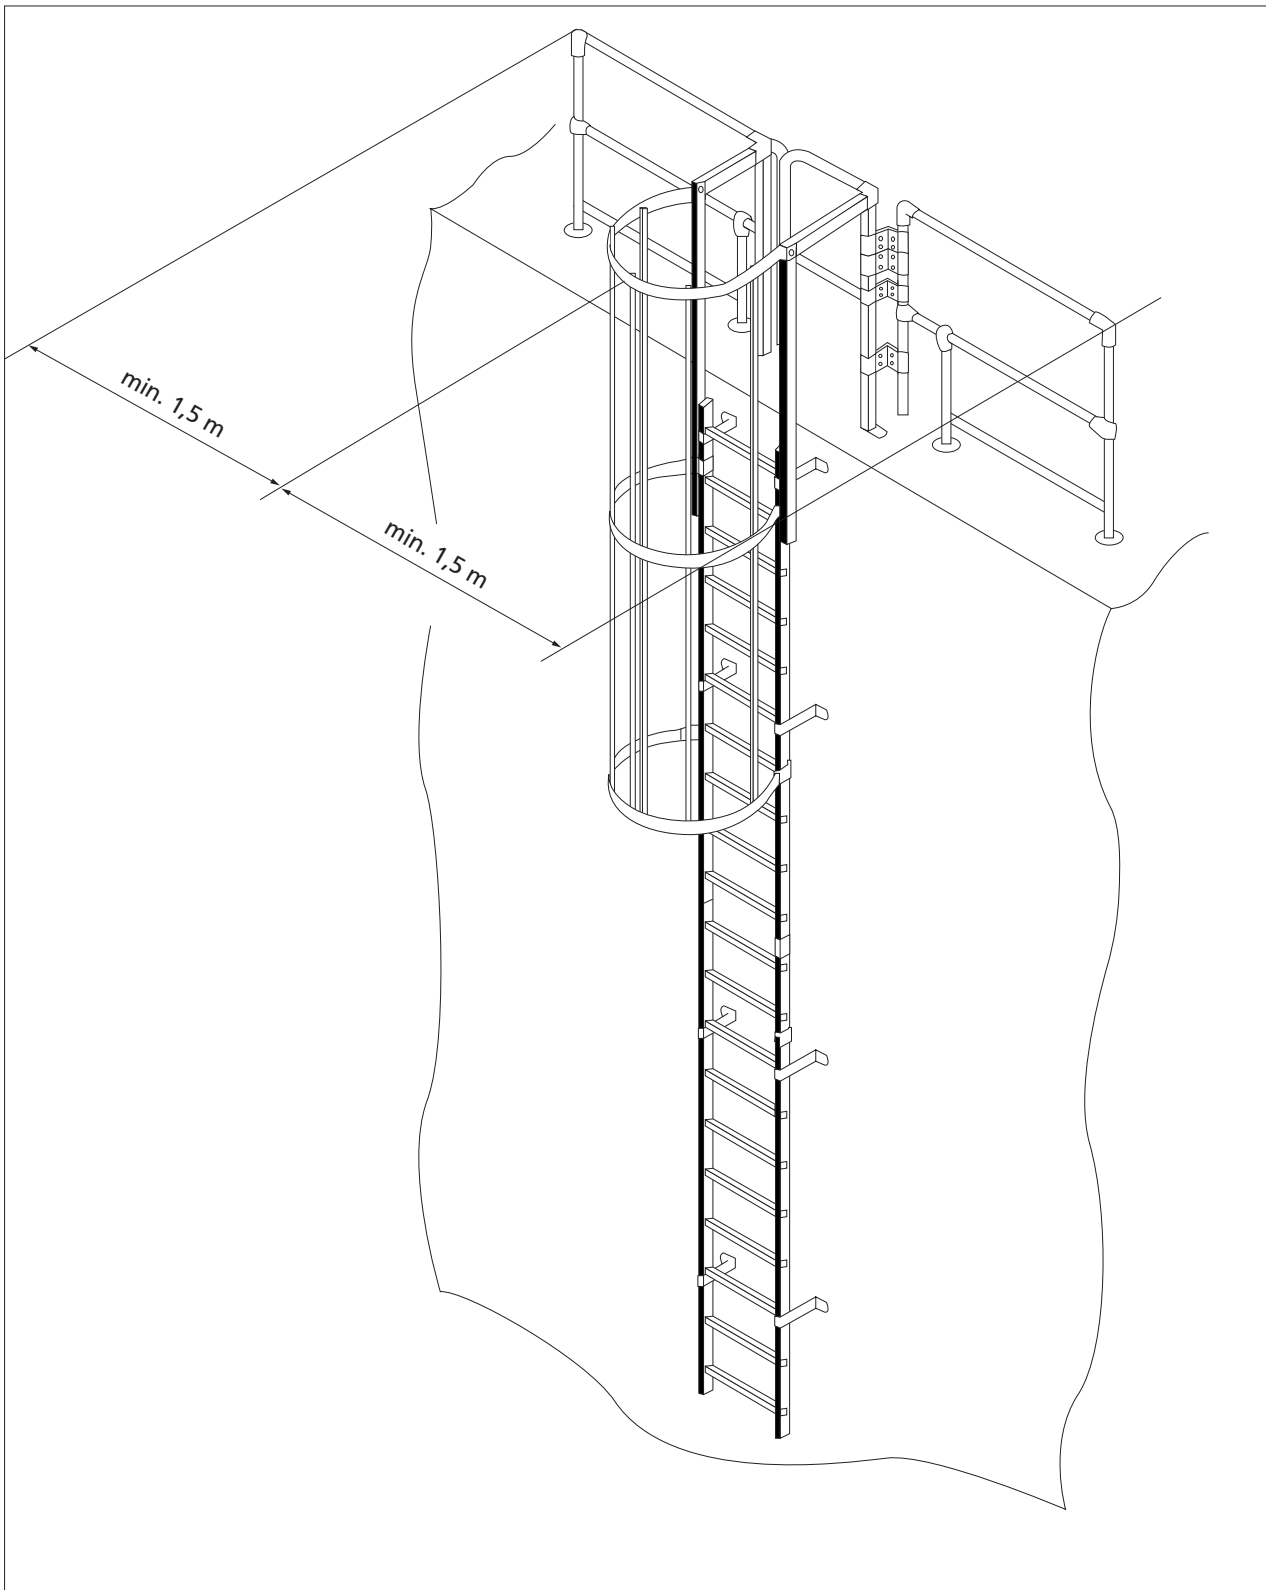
Echelles fixes avec un portillon à fermeture sur le garde-corps à la sortie selon la norme DIN 18799-3
